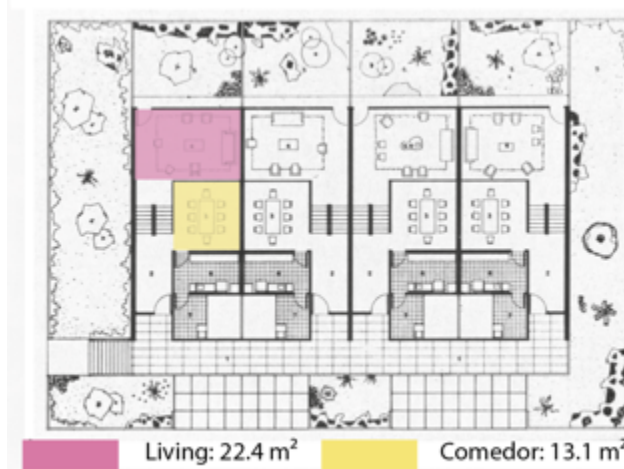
Planta del piso principal – (edificio de tres niveles) – Ricaurte, Carrizosa, Prieto – 1955
